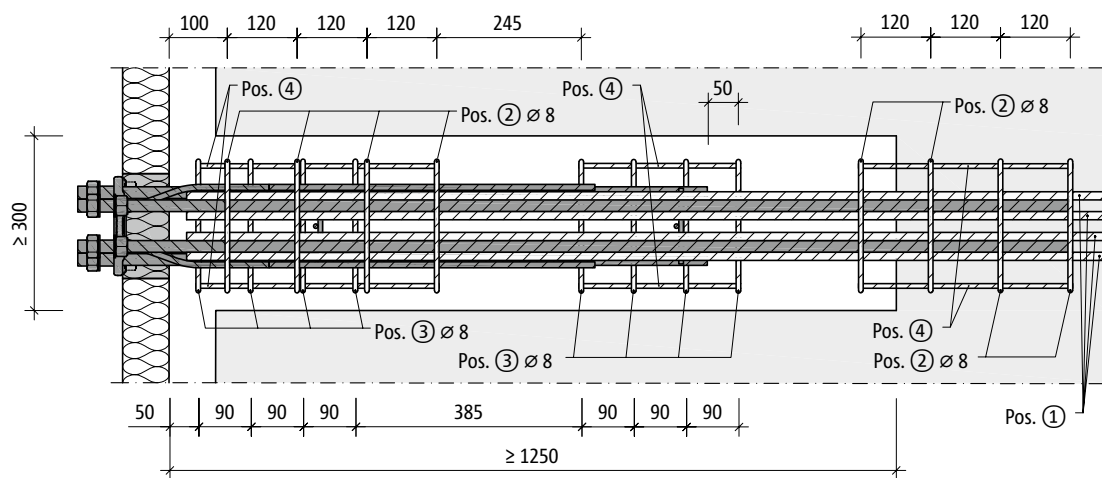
Schöck Isokorb® T Typ SKP-MM2: Bauseitige Bewehrung bei Halbfertigteilbauweise, Grundriss
